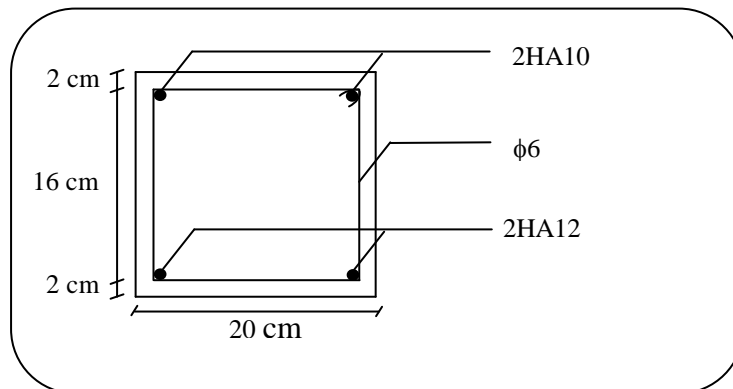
Schéma de ferrailage du chaînage 4
